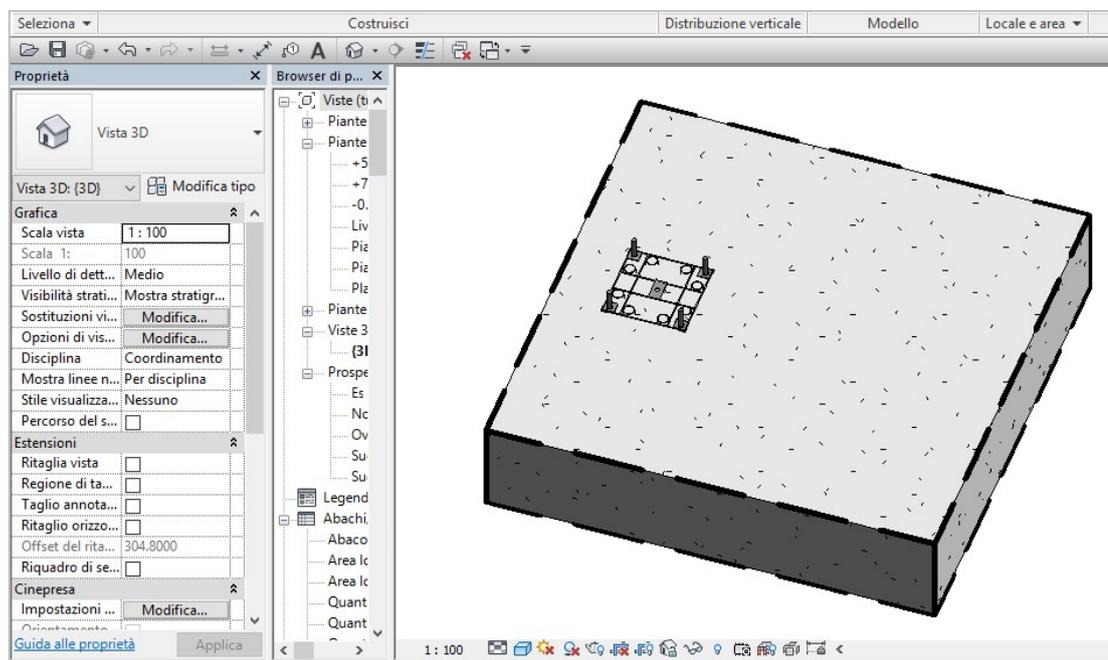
Creazione degli elementi di connessione strutturale detti "innesti di fondazione" su Revit.
